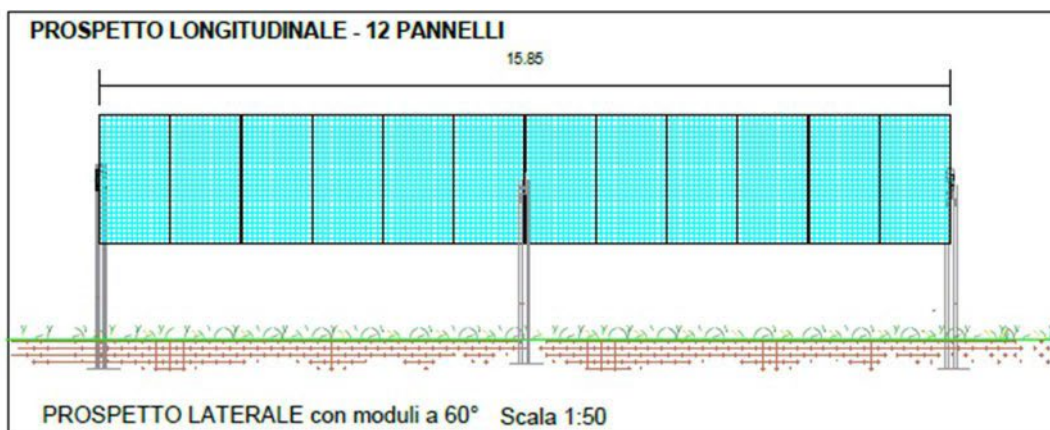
Strutture di sostegno in pianta 12 moduli
